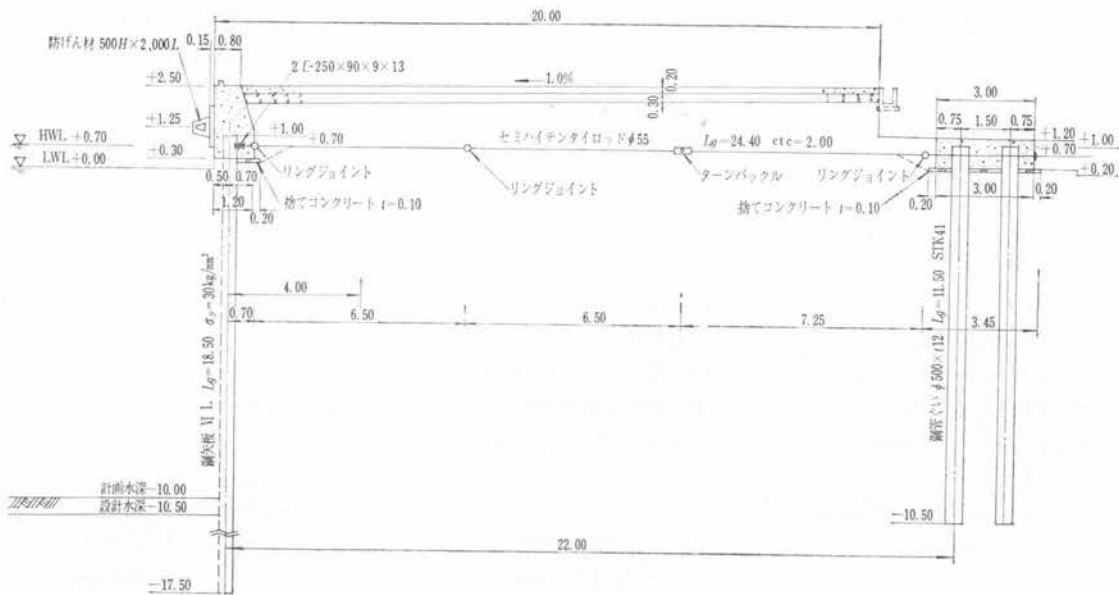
新潟東港物専岸壁 (-10 m) 標準断面図
